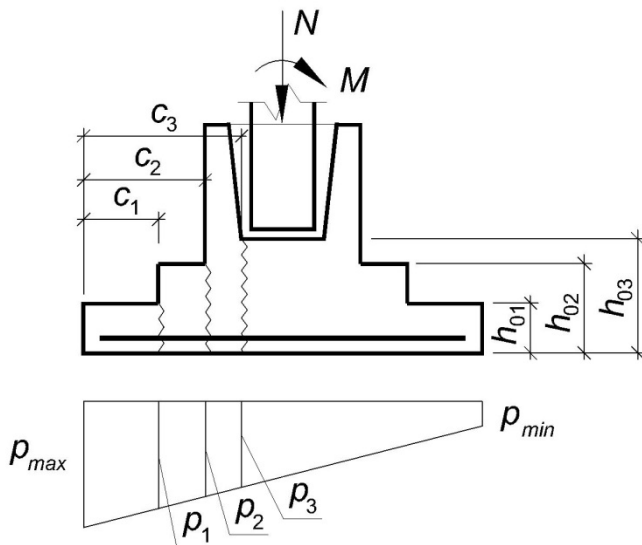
Расчетная схема к определению площади сечения арматуры плитной части фундамента под колонну
